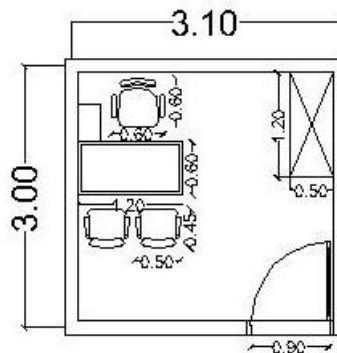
Studi Ruang Kamar Tamu Tipe *Presidential Suite Room
